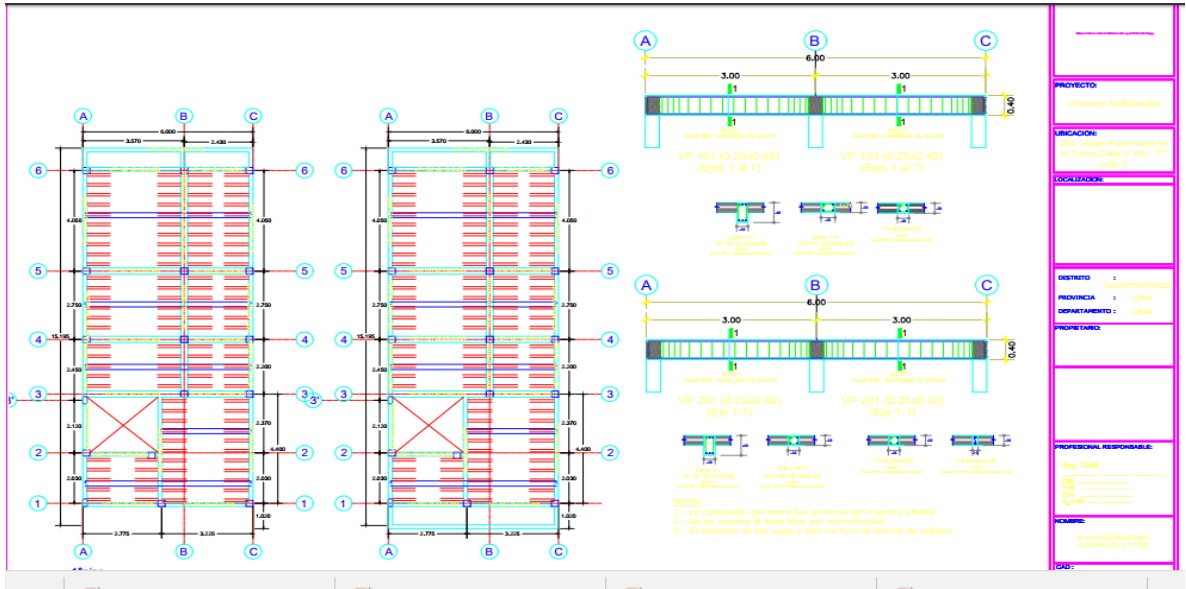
13: plano de planta de primer y segundo piso, fuente propia
